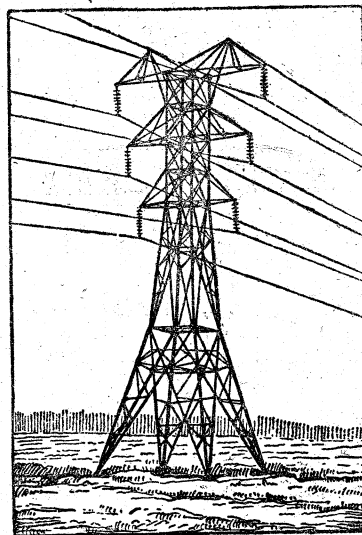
Металлическая опора для двух трехфазных линий 110 кв с двумя заземленными защитными тросами.
